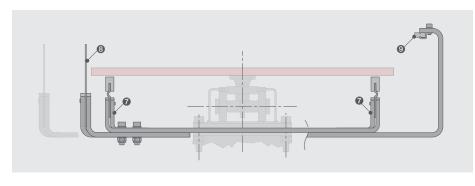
Typ PL Abstützung durch Stahlblechstreifen (7) – links mit Blechführung (8) – rechts mit Profilführung (9)
